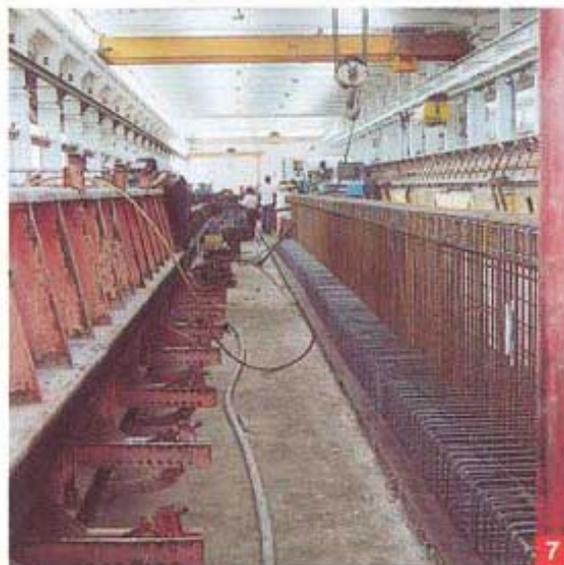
A destra pista travi prima della cassetatura, a sinistra pista travi in fase di getto.
